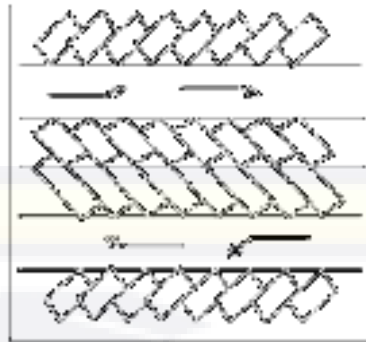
Pola Parkir Bentuk Tulang Ikan Tipe A
